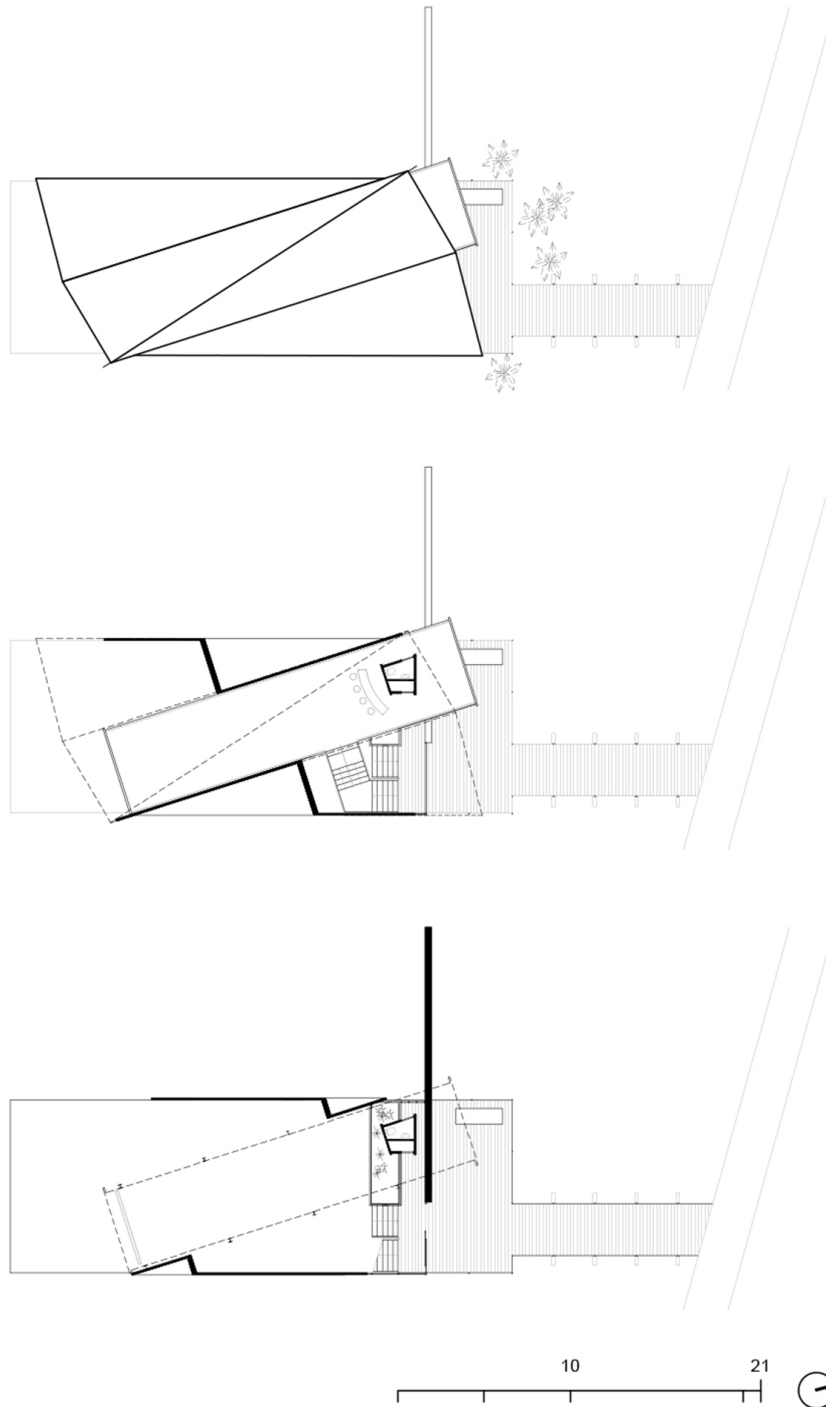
Plantas de cubierta, superior e inferior (fuente: El autor).
